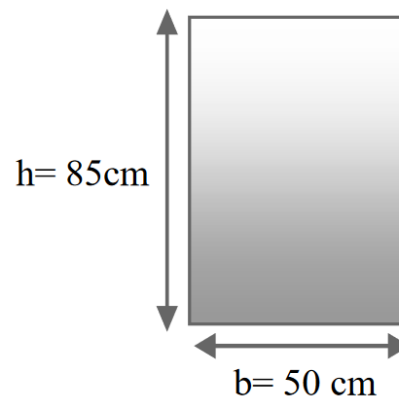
Dimensions du section de la poutre principale(50x85)
